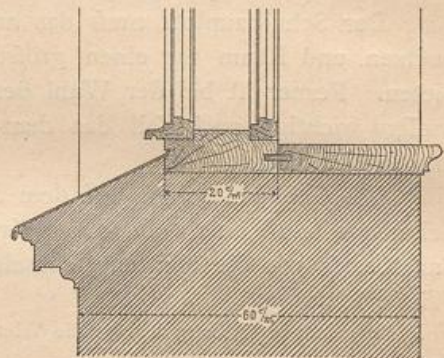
zeigt das Schema einer Fenster-Construction für Massivbauten.
